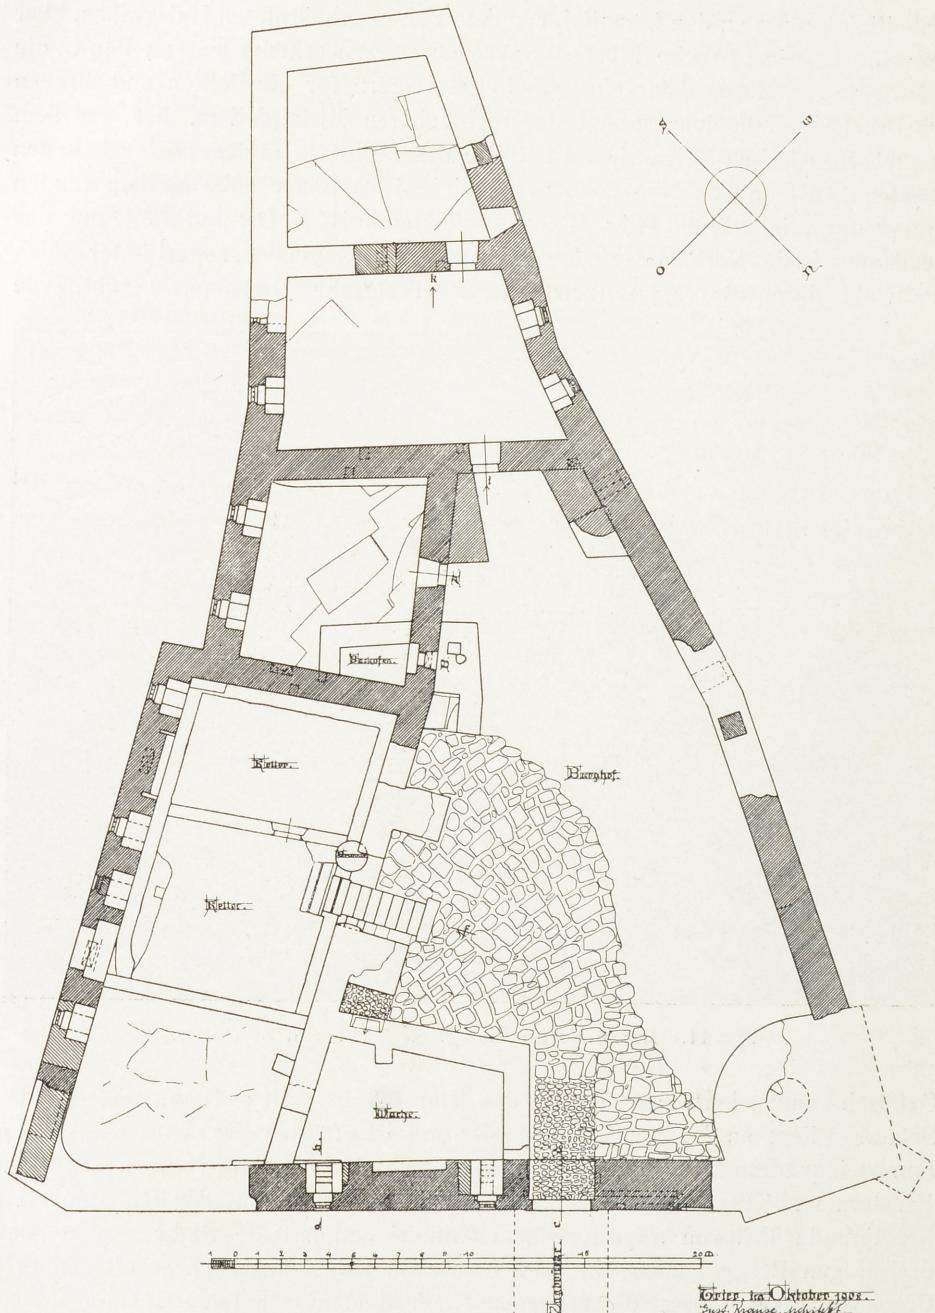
Ruine Freudenburg. Grundriss des Erdgeschosses.
